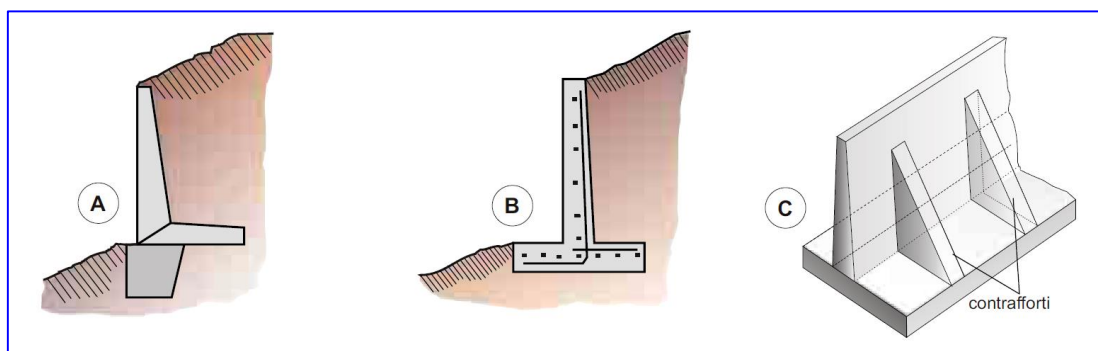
Tipologie di muri a mensola a) in elementi pre-fabbricati di cemento armato, b) in cemento armato gettato in opera, c) in cemento armato gettato in opera con contrafforti interni (Fonte: Marasciulo et al., 2002).
